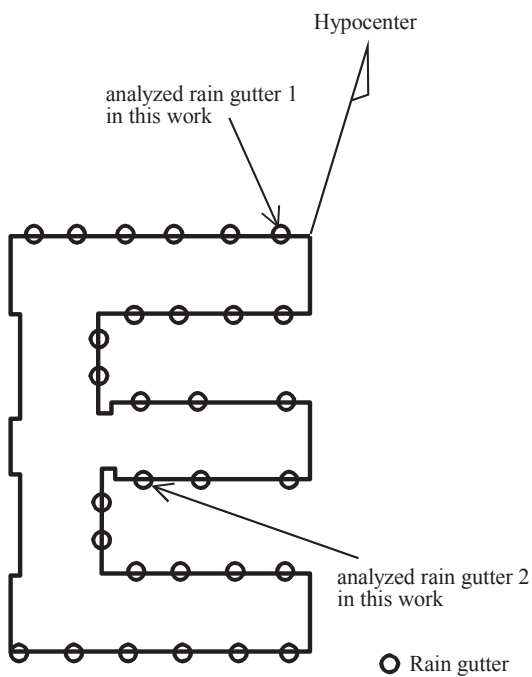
雨樋試料 1 および 2 の旧広島文理大建物（平面図）での採取位置
